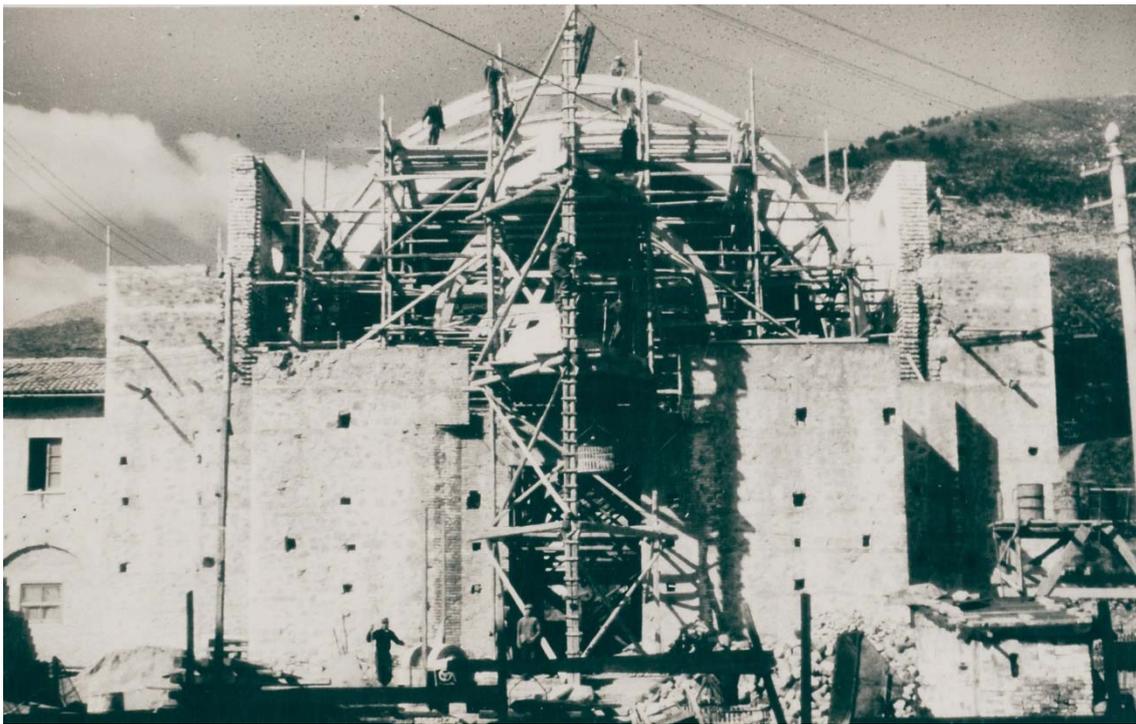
1948 - Il prospetto principale della chiesa durante il cantiere (ASV)
